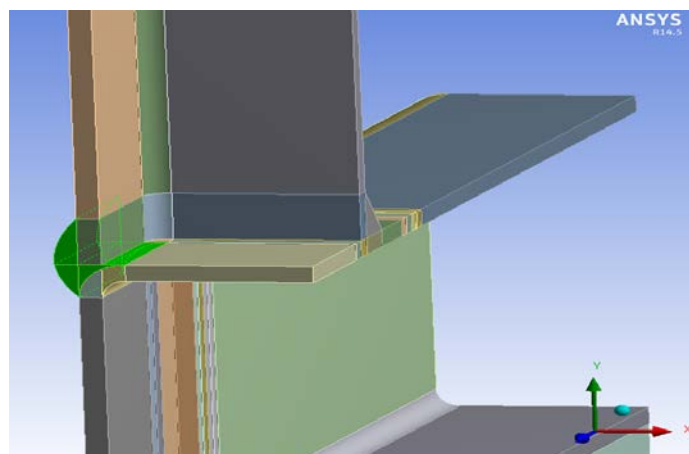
Modelo 3. Contactos: Montante sobre cordón y soldadura exterior
